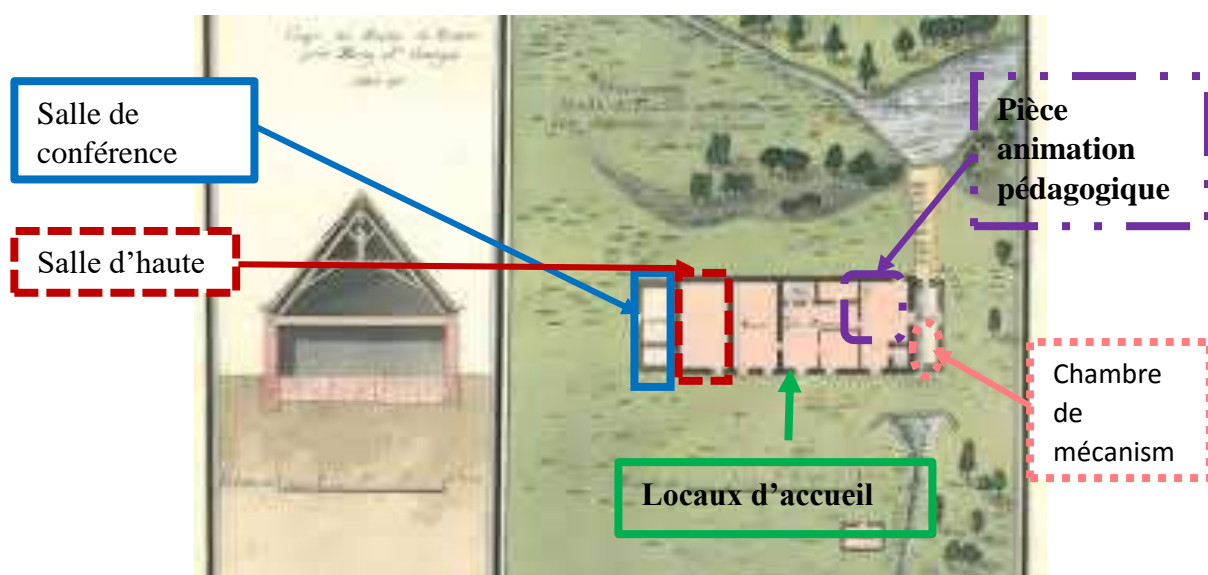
plan et coupe du moulin Russon après les travaux de restauration
